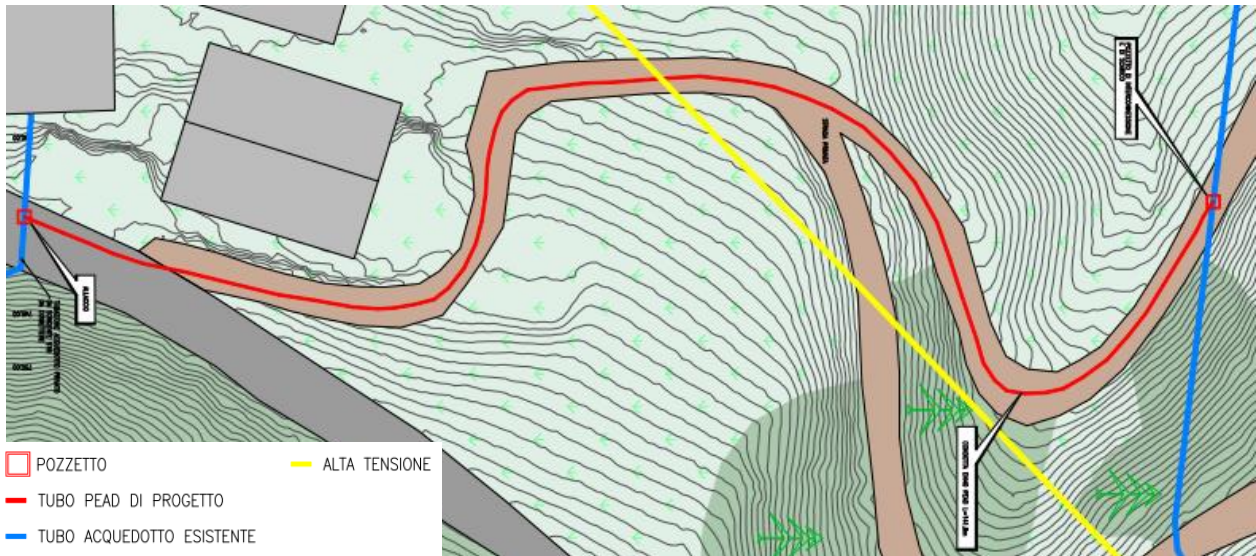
Estratto planimetria sottoservizi sorgente S18
